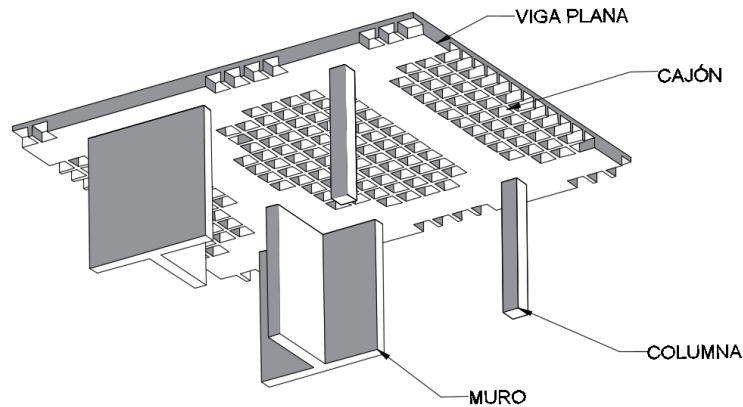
Sistema de muros, columnas y losa plana alivianada.
